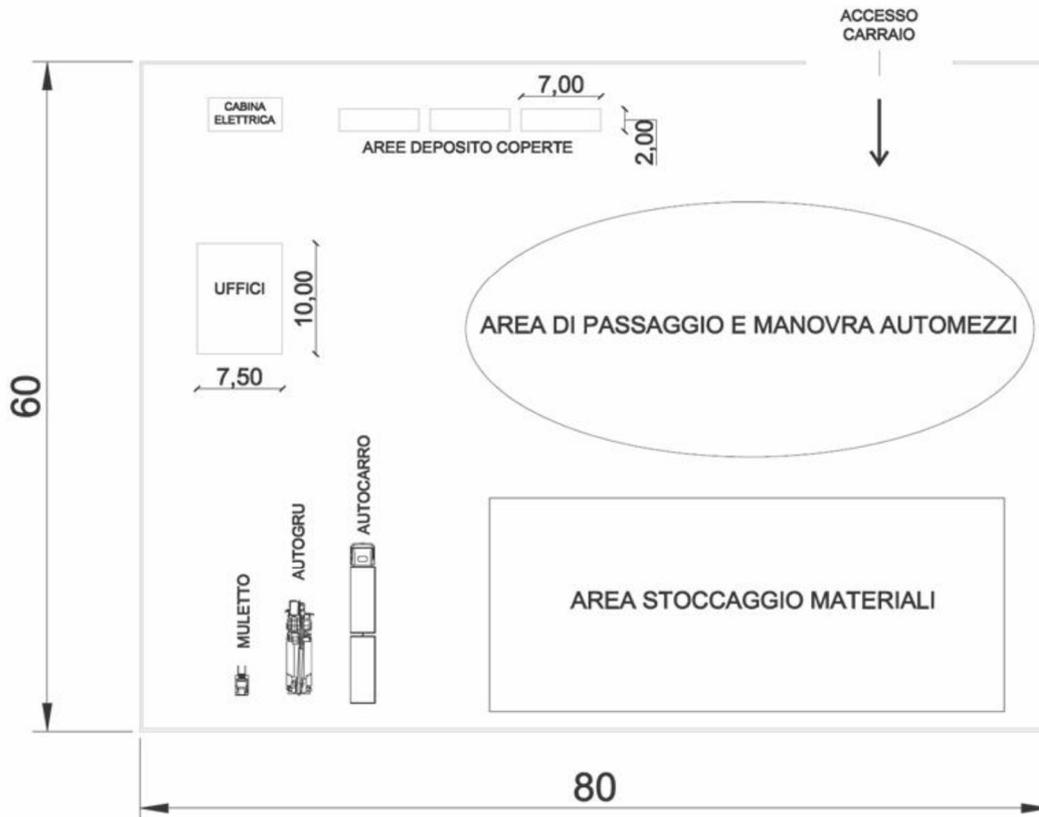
Planimetria dell'area centrale di cantiere - misure indicative
